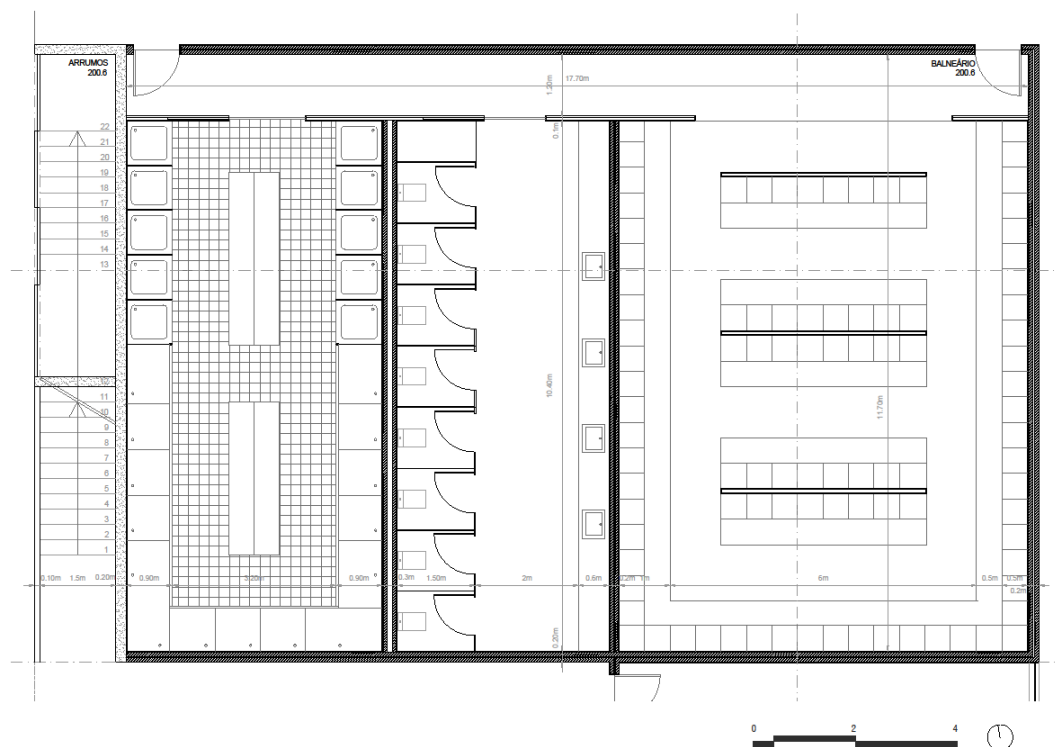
Proposta: Planta Balneário, Fonte: Autor
